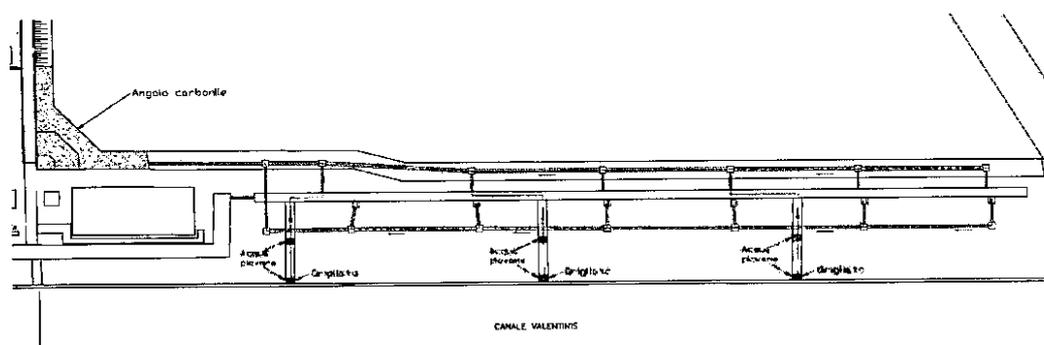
Planimetria rete fognaria banchina lato Monfalcone
